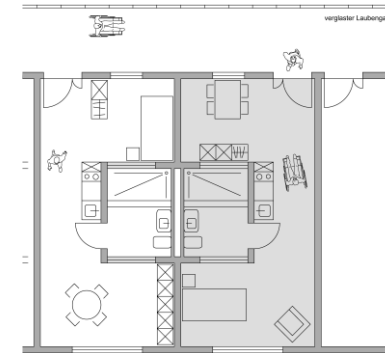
Schema Studio mit zwei gleichwertigen Wohnbereichen
